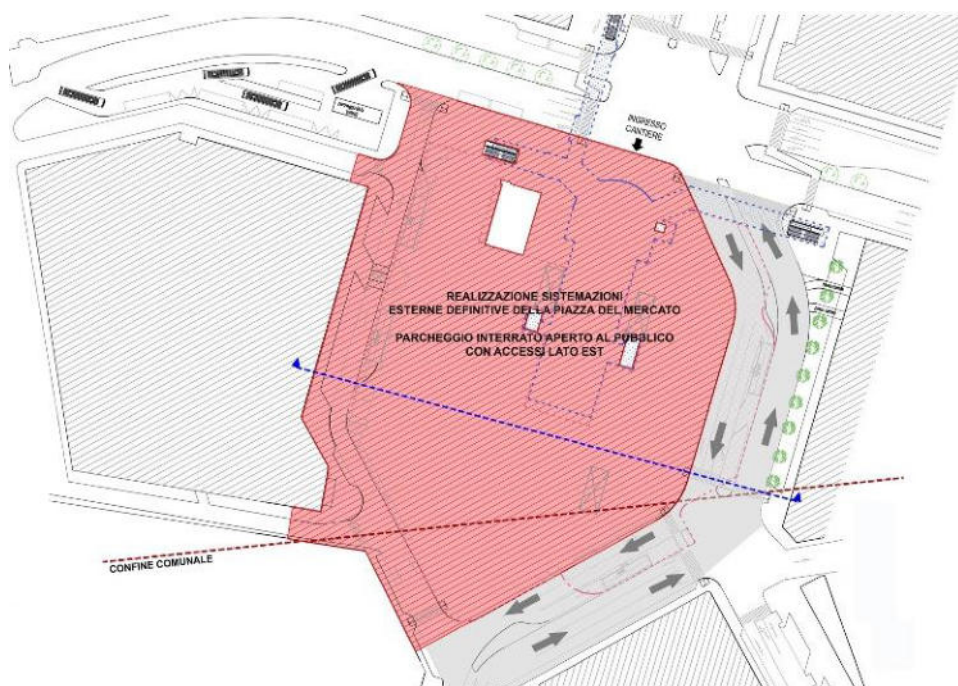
Pianta e sezione dell'organizzazione di layout per la Fase 2
